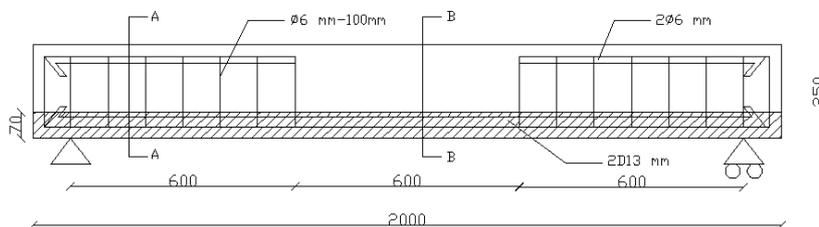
Sketsa Benda Uji Balok Perbaikan 40 cm
